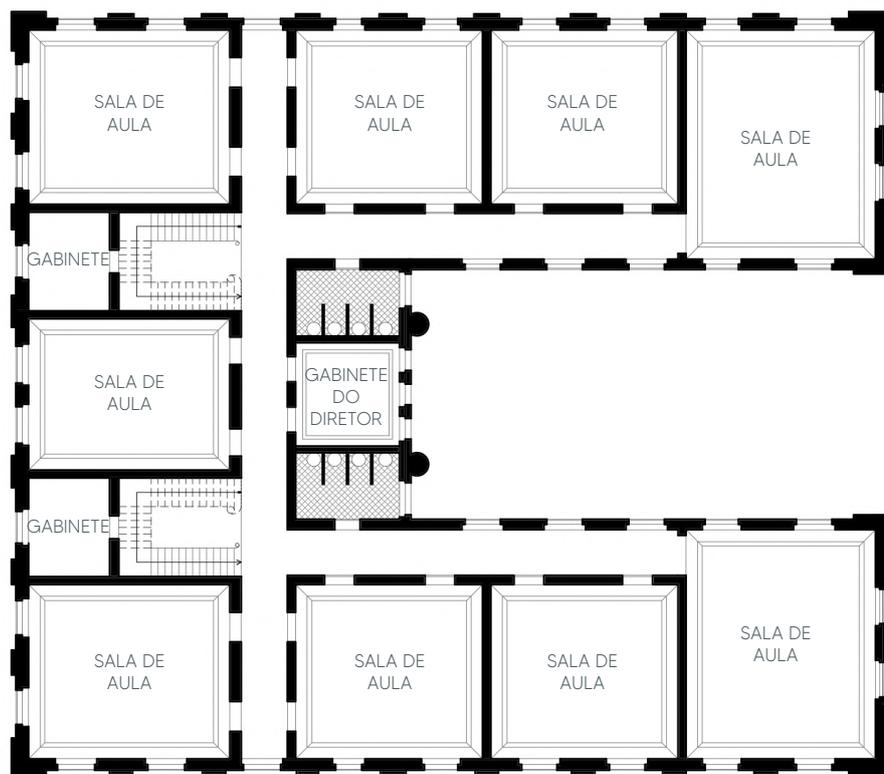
Redesenho da planta do pavimento superior (planta da época da construção).
